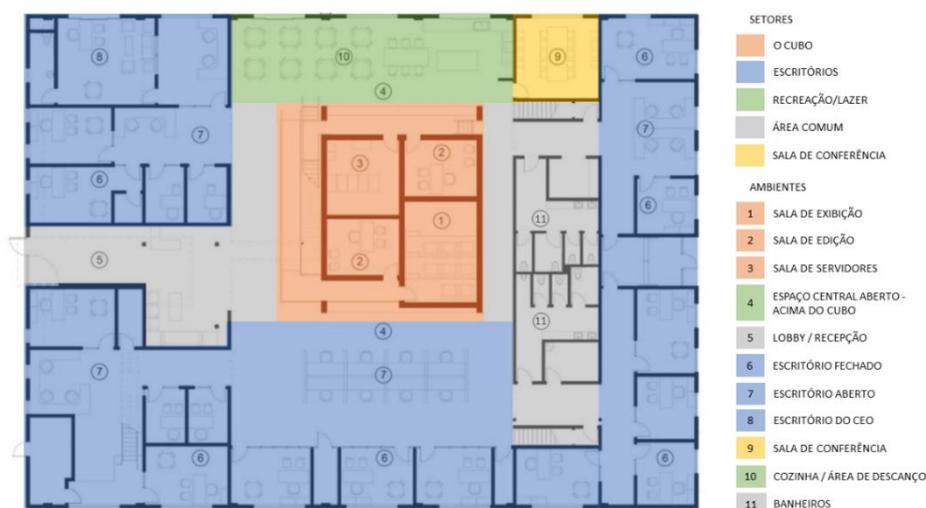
Setorização – Estúdio Santa Monica, Planta Térrea
